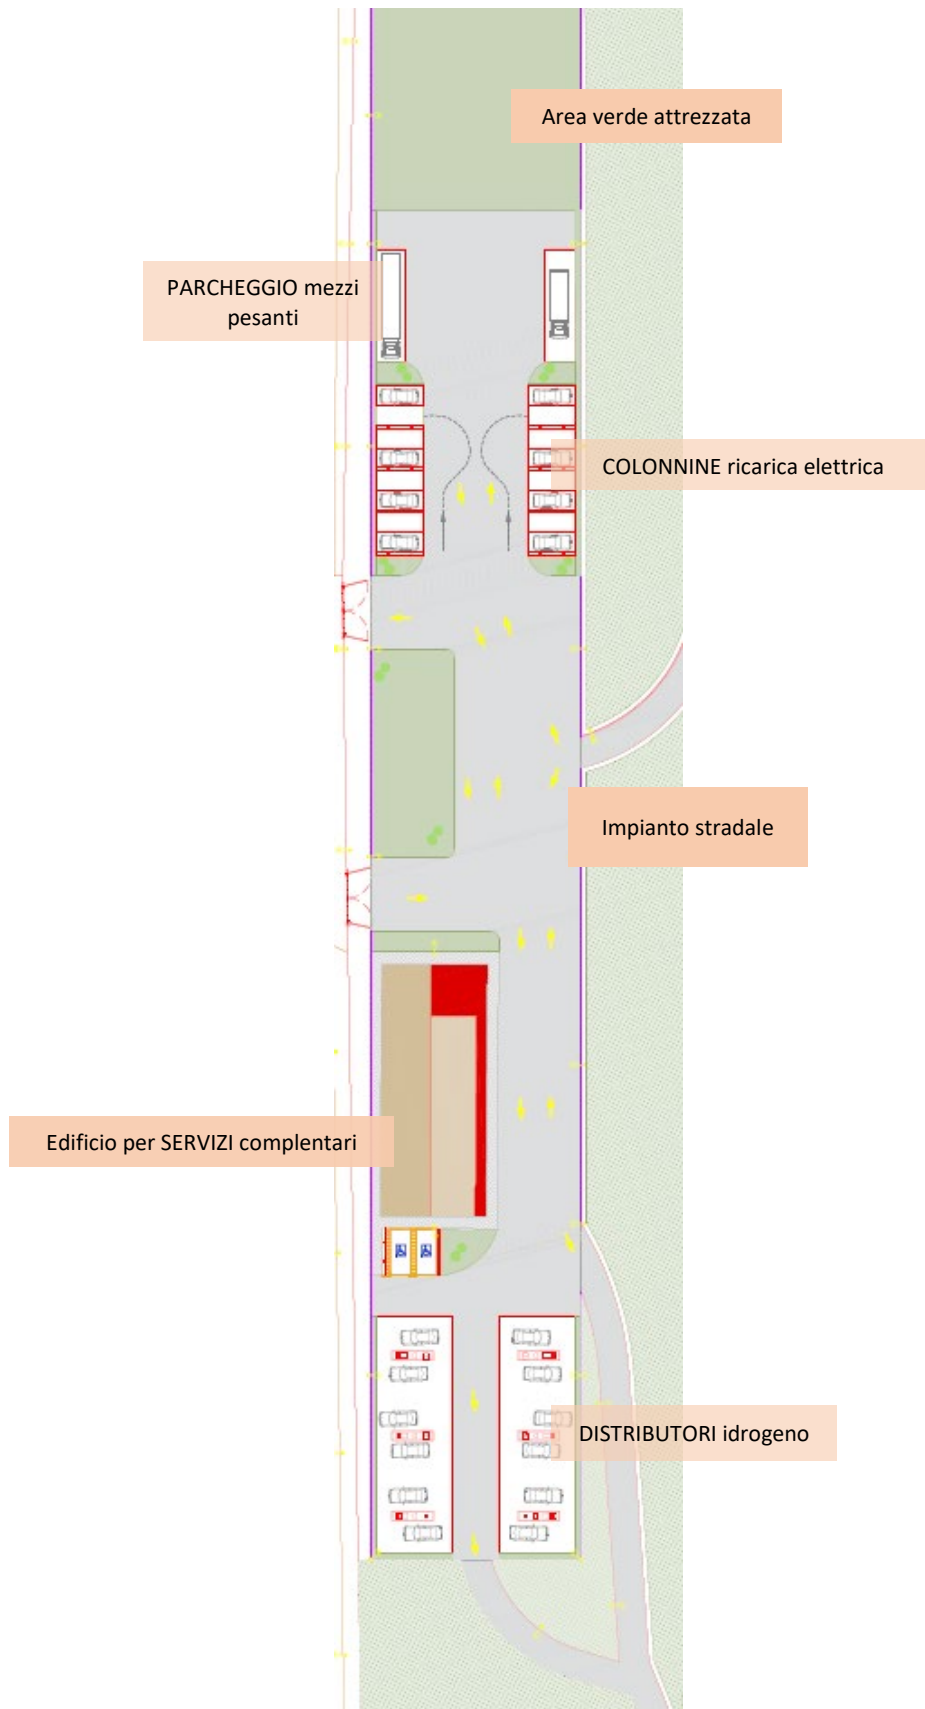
Planimetria Generale di Progetto del sito di distribuzione dell’Idrogeno
